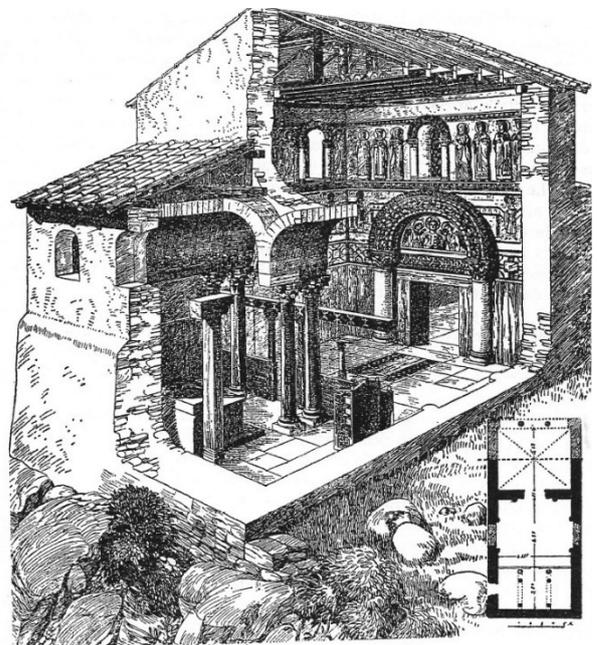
Saggio di ricostruzione della pianta e dell'aspetto originale del Tempietto, proposto da A. Haupt.
